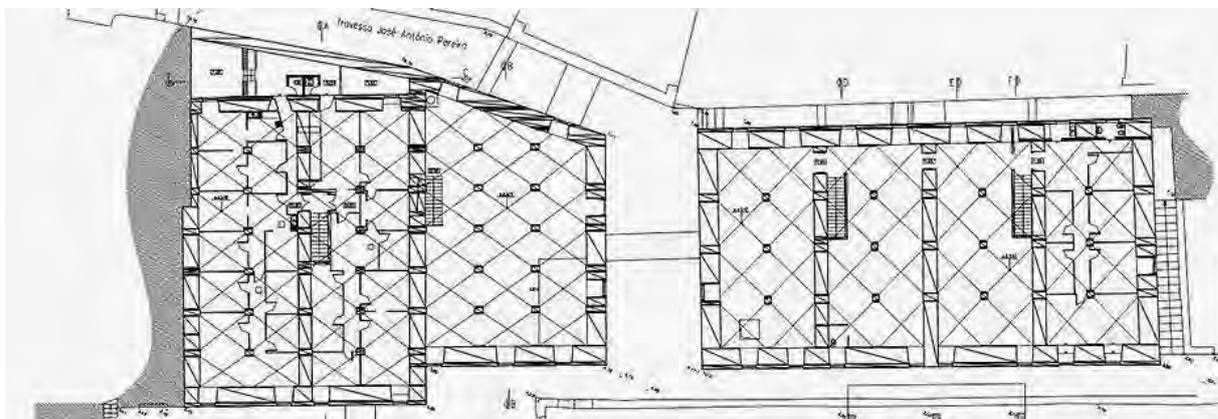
b – Levantamento arquitetónico das tercenças (parte): armazéns a norte do edifício principal, com acesso pela trav. José António Pereira: plantas. Fonte: <http://www.cubismo.pt/>
